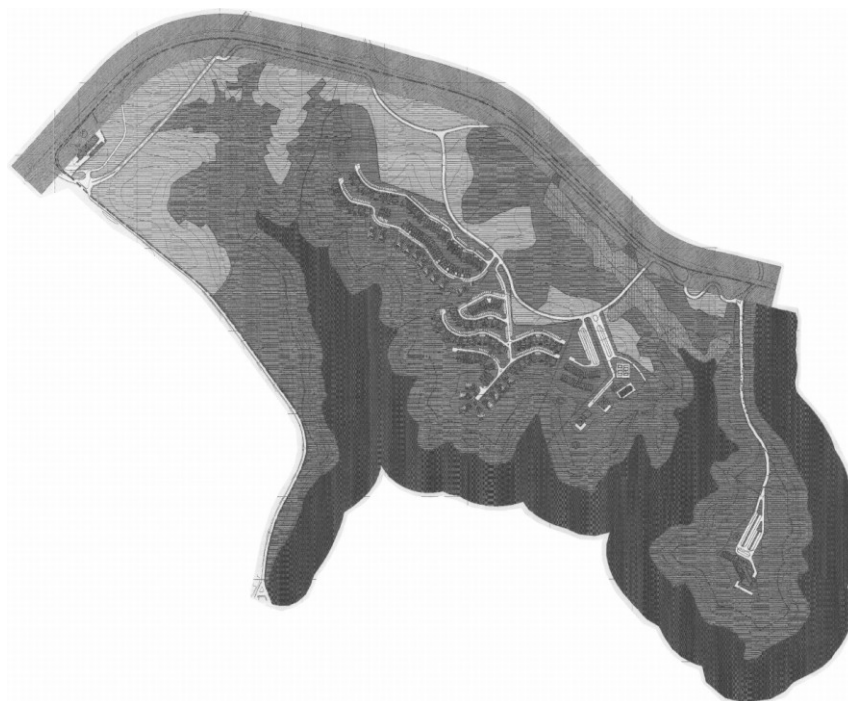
Plano de Pormenor do Crafuncho(fonte: Declaração n.o 84/2003-2.a série)
